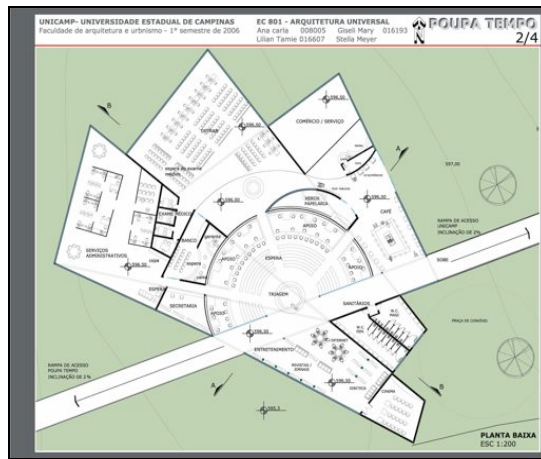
Planta do pavimento térreo do Projeto “A” (s/esc.).
